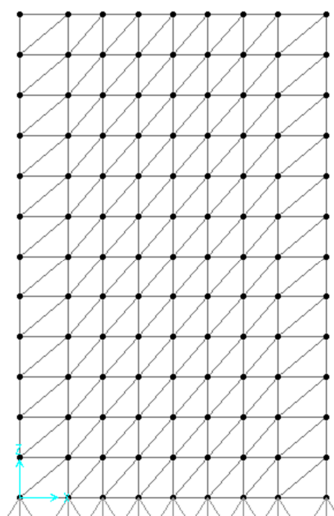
Configuração dos Planos de Contraventamento Vertical Com Elementos de Contraventamento Pequenos
